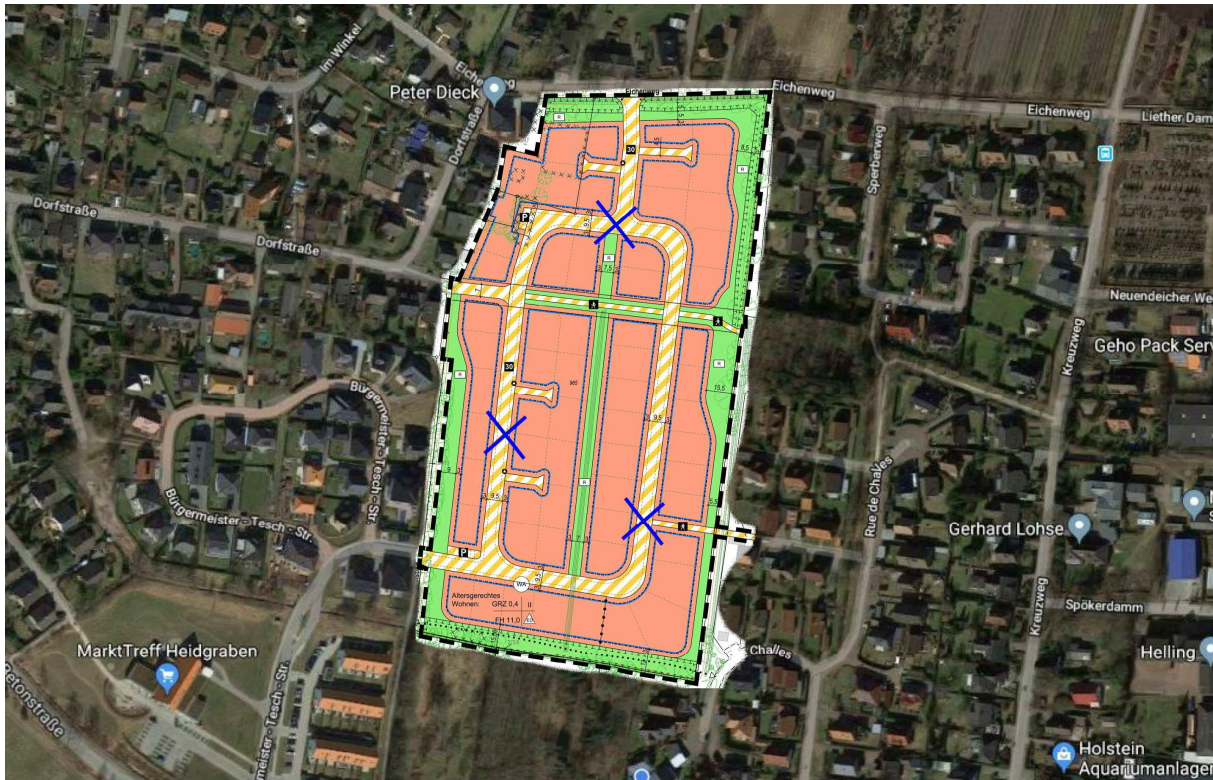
Lageplan mit Kennzeichnung der zusätzlich geplanten Hydranten
